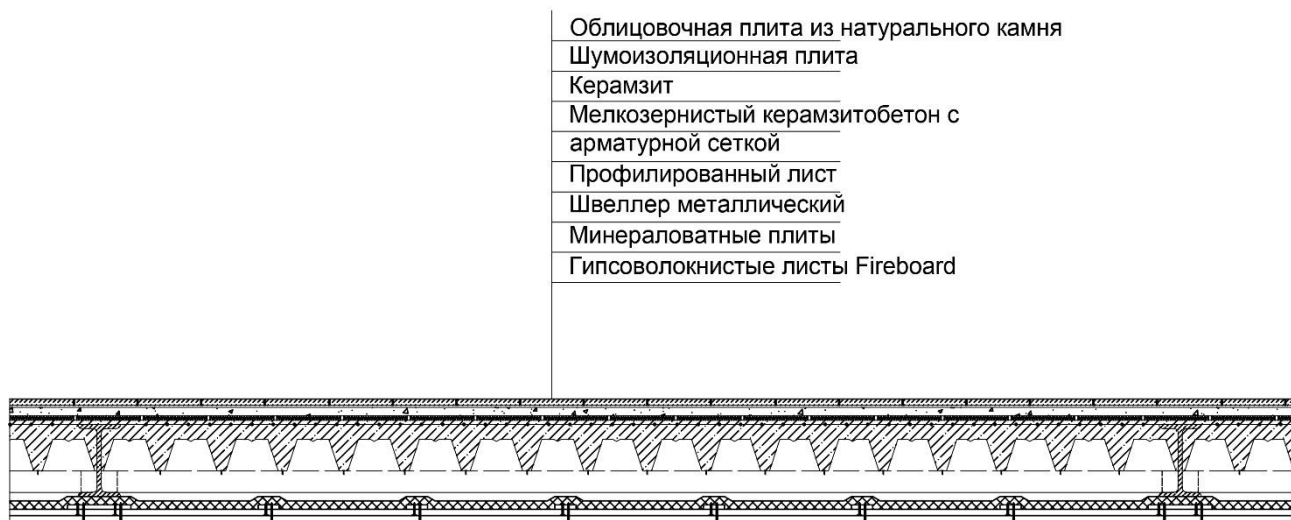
Междуэтажное перекрытие (узел выполнен на основе интернет-ресурса:)
